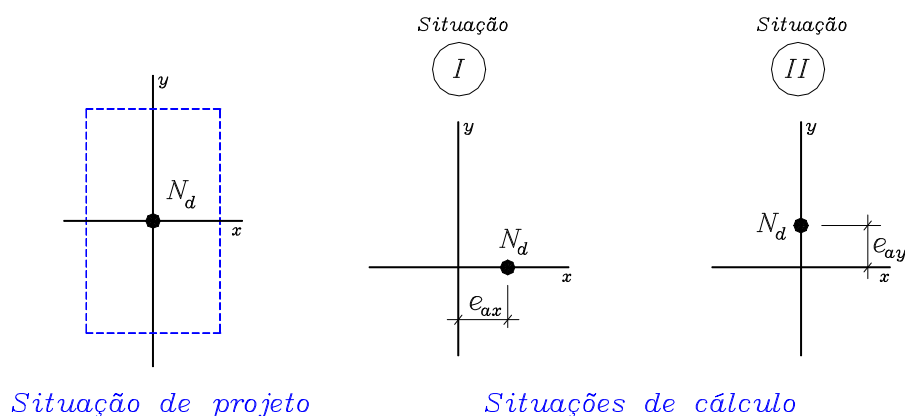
Situações de projeto e de cálculo para o pilar P1
